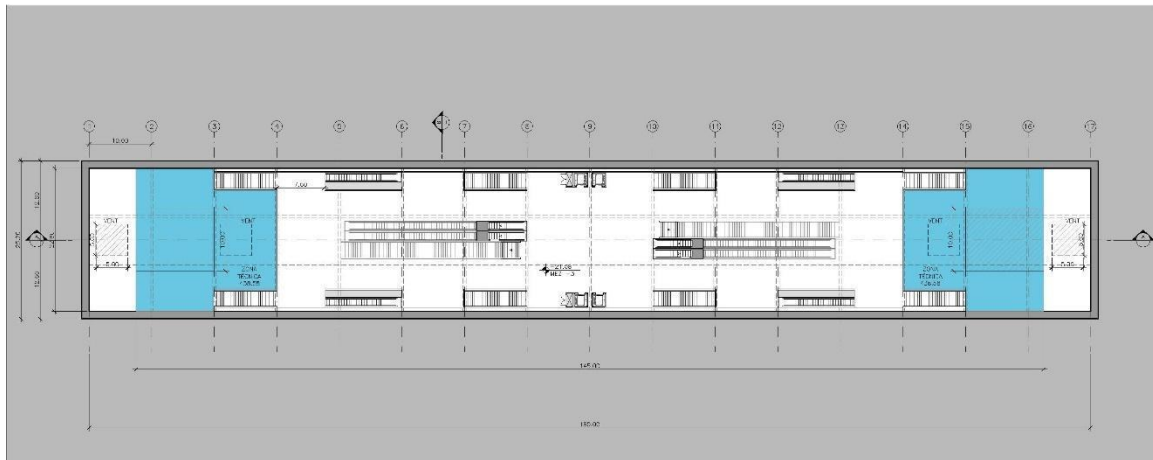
Planta Nivel Intermedio -3 (-21,08)
